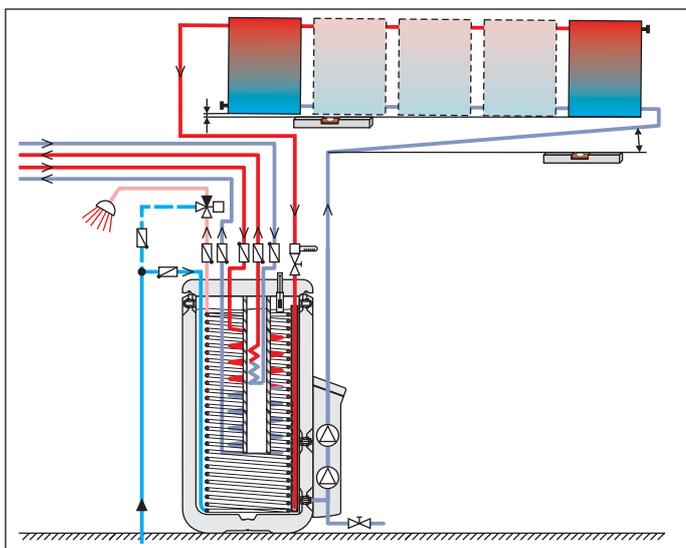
Campo solare dei collettori con collegamento incrociato e accumulatore di acqua calda EKHWP* ⁽¹⁾ tipo di collegamento consigliato da DAIKIN
